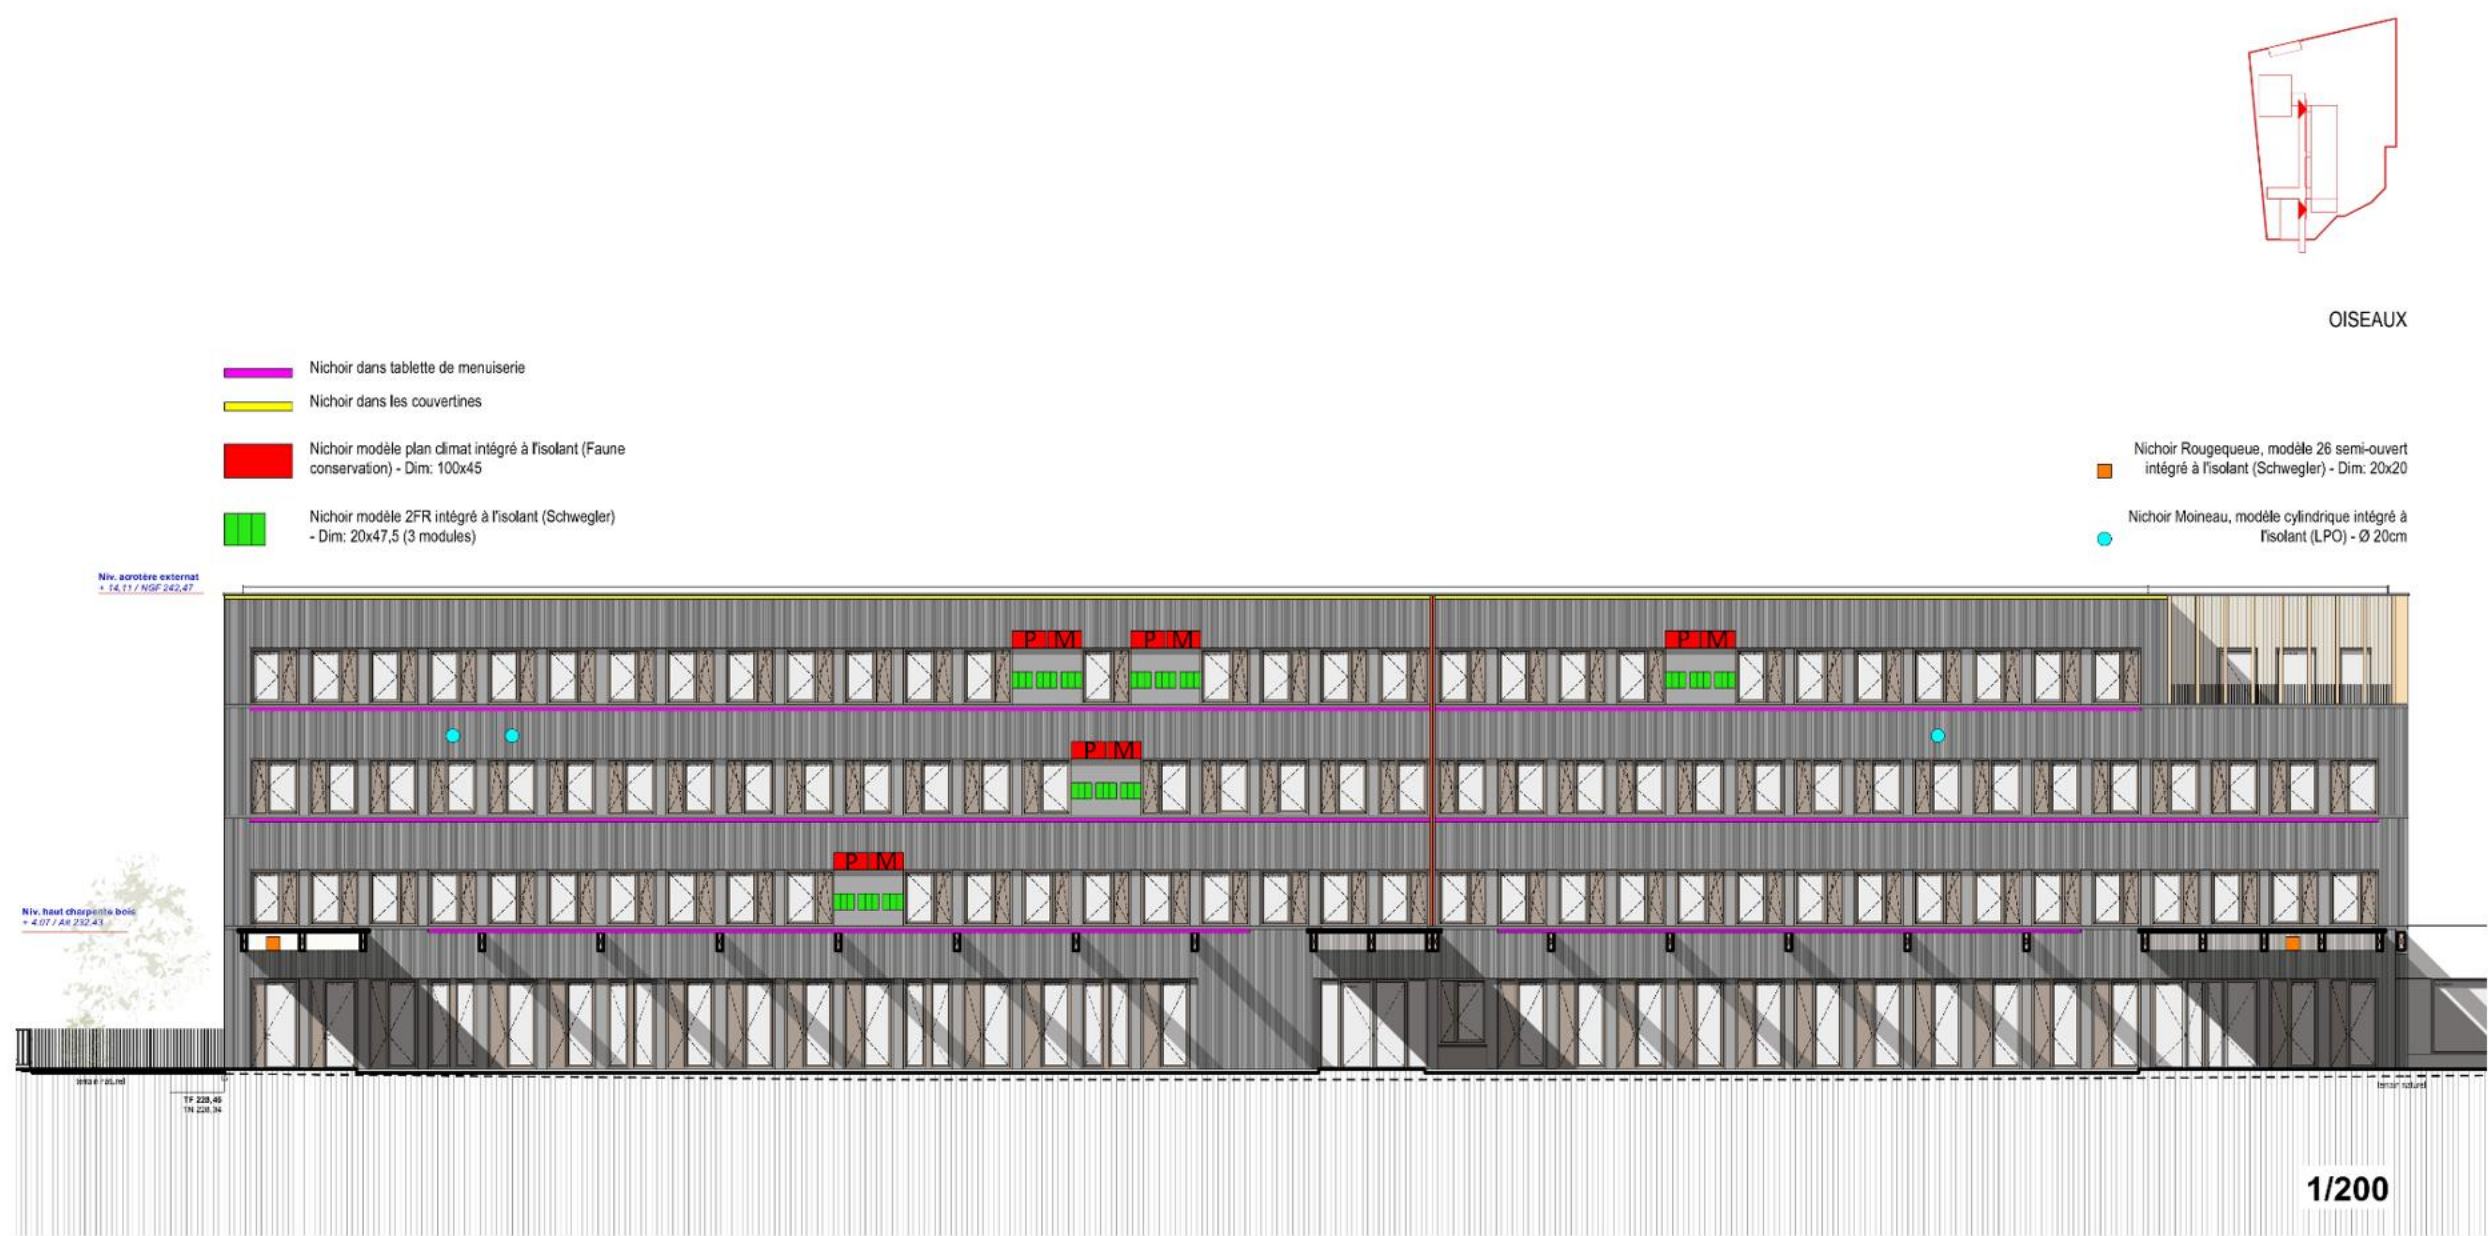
Localisation des gîtes compensatoires sur le bâtiment externe - façade ouest
